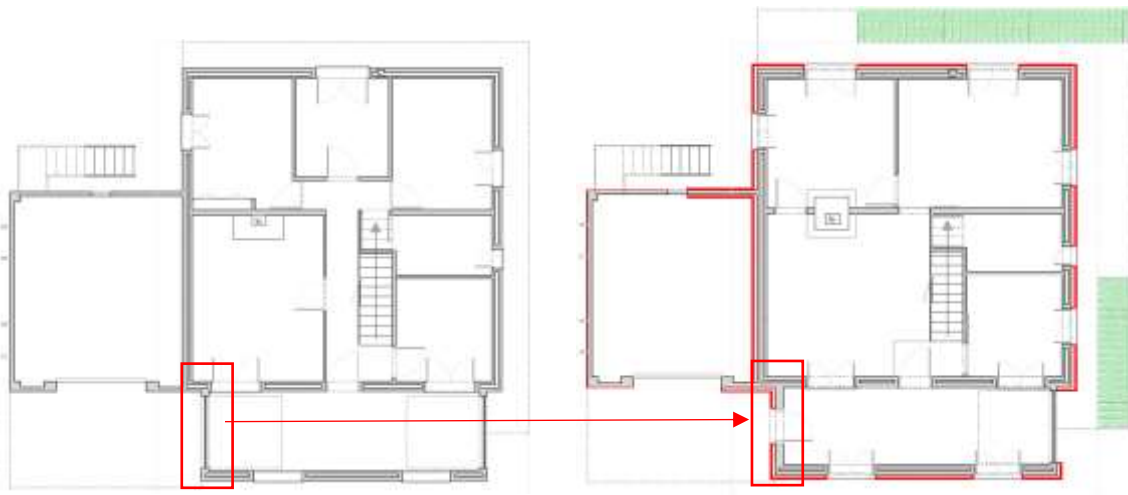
PLANTES AMB VENTILACIONS CREUADES. IMATGE DE L'ESQUERRA PLANTA PB I LA DE LA DRETA PLANTA P1.
